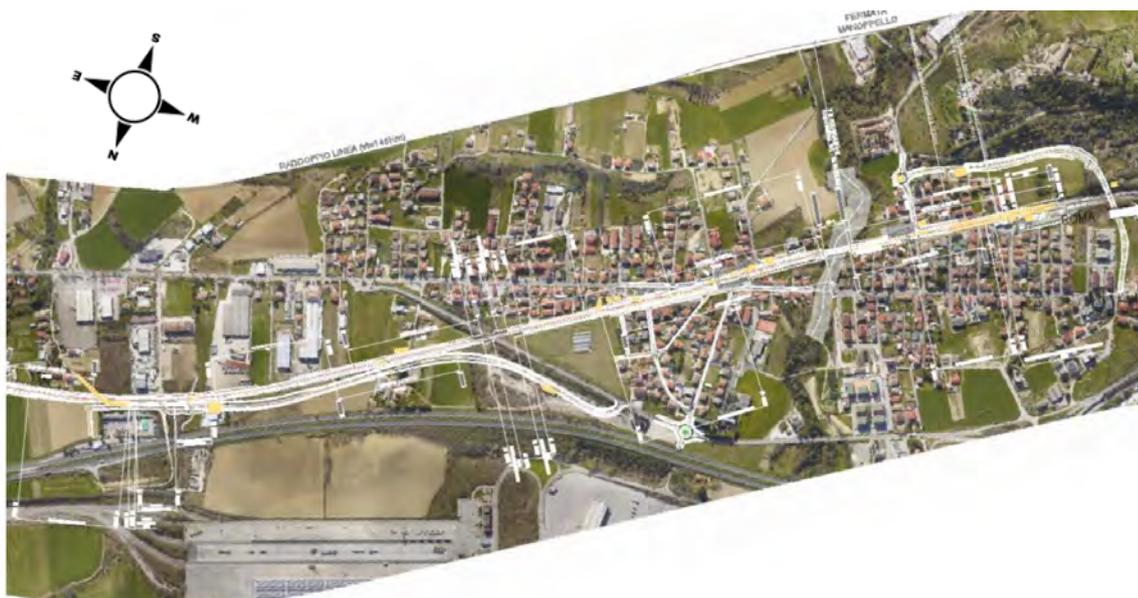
Inquadramento planimetrico su ortofoto (Tratto sud - Comune di Manoppello)
